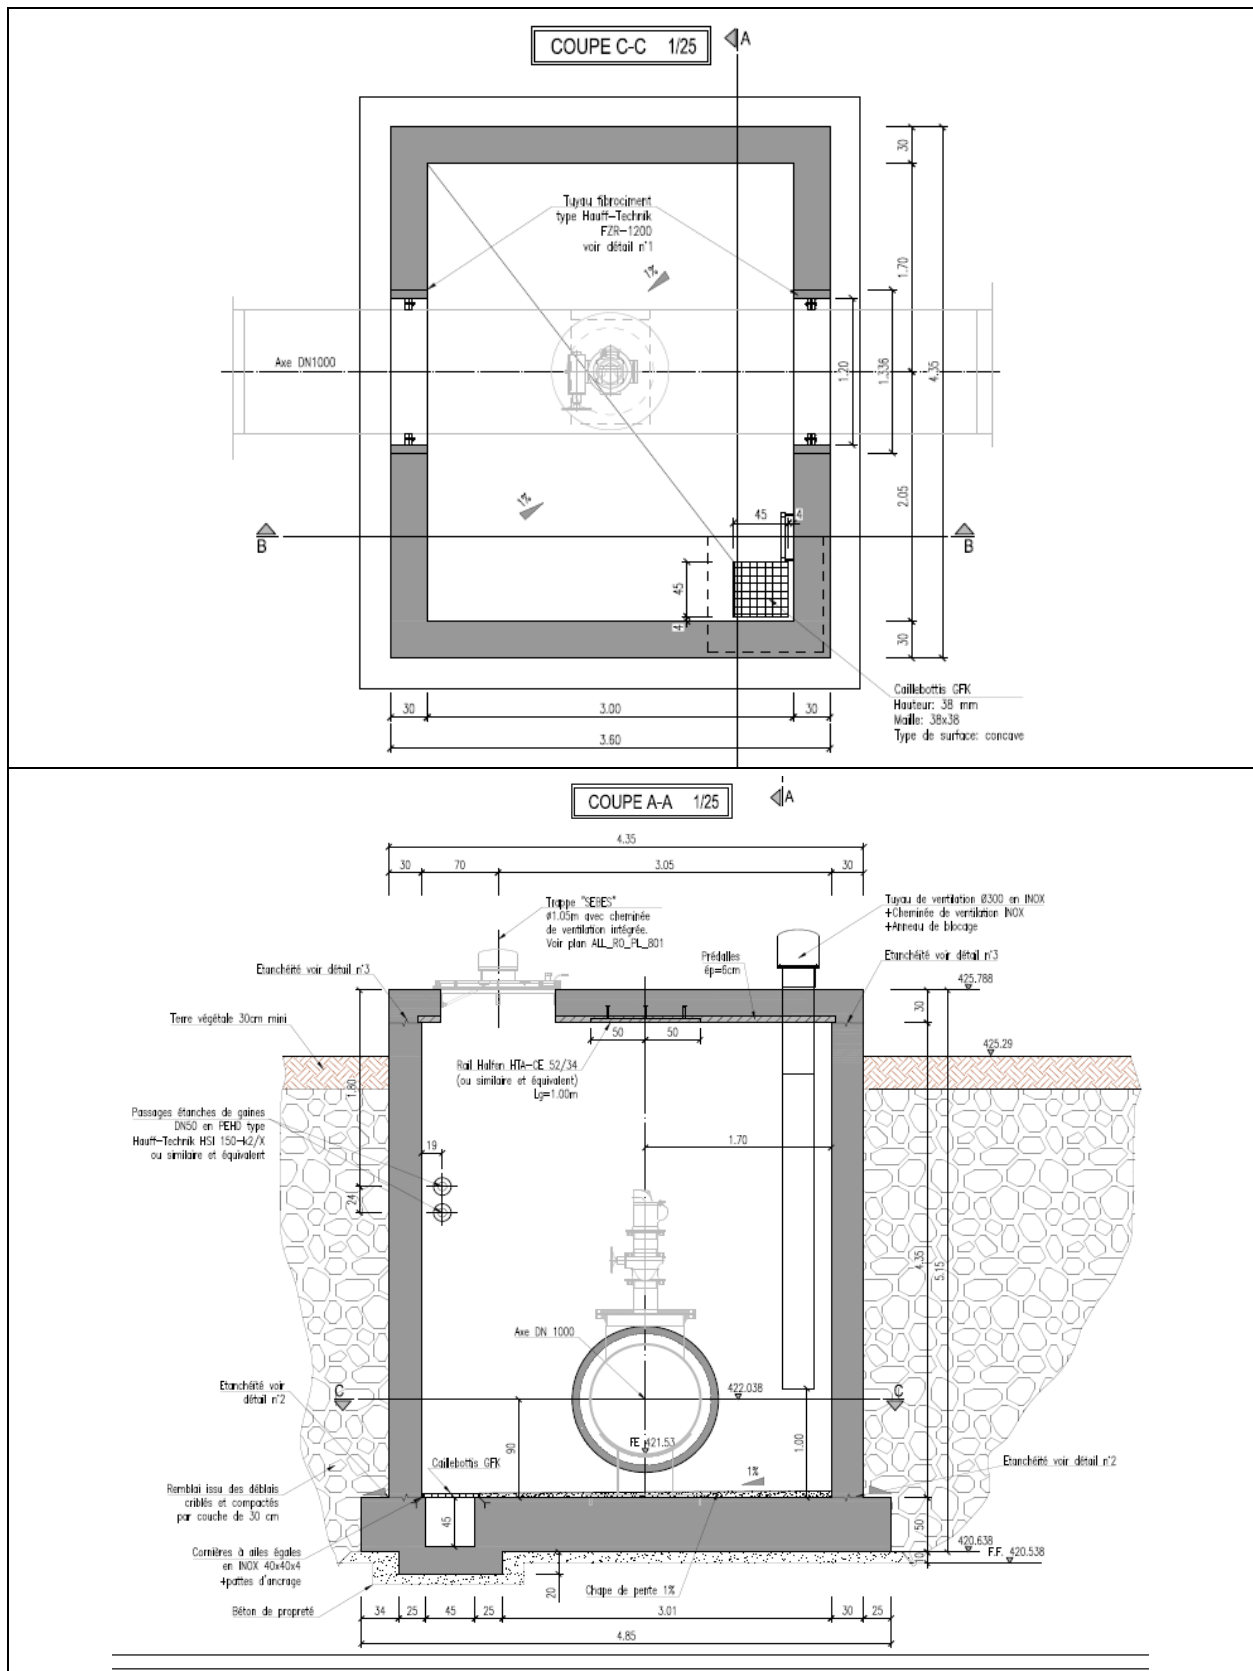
Grundriss und Querschnitt Hochpunkt (PH) - Prinzipskizze
